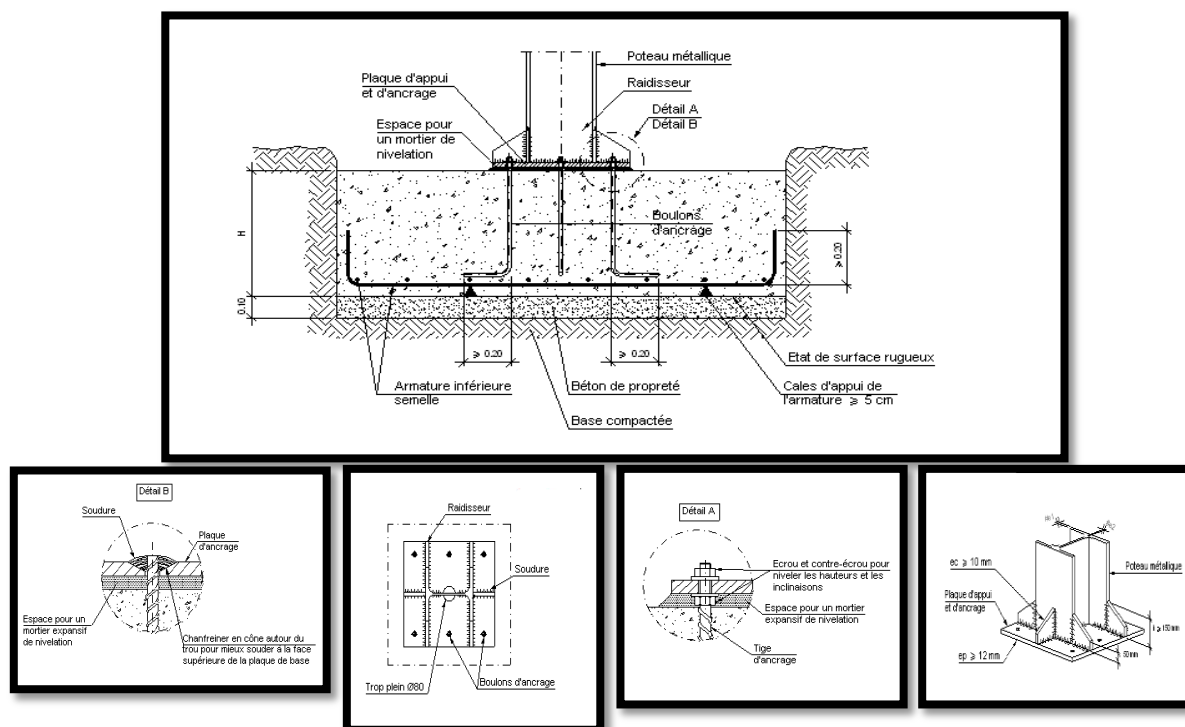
Détail encrage poteaux fondation source <http://detailsconstructifs.cype.fr/EAC803.html>
